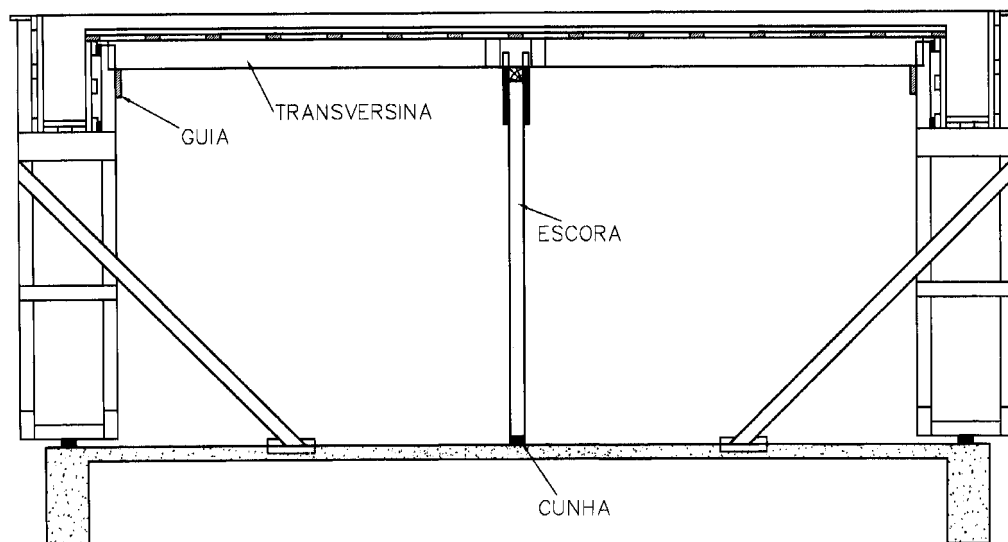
Seção dos componentes de laje (Fonte: Mauro Satoshi Morikawa).
